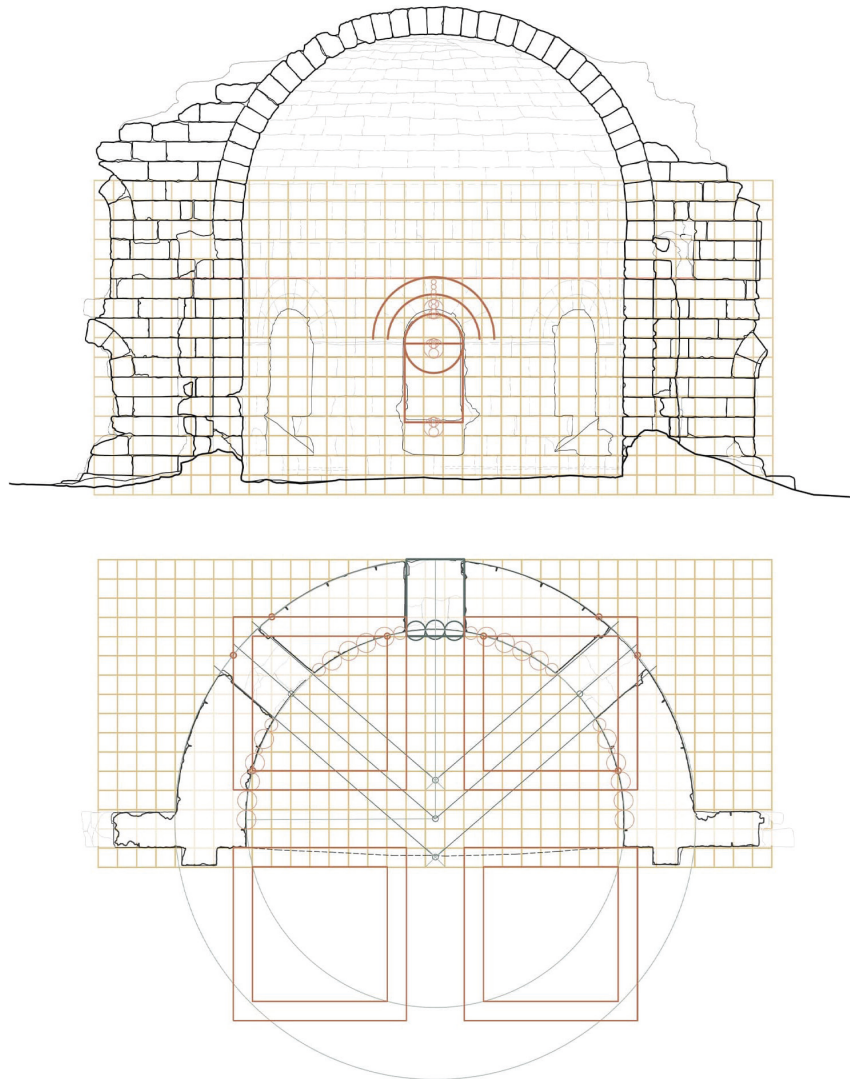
Studio geometrico in prospettiva e pianta su griglia di modulo 49 cm (un bes) (@AskGate).
